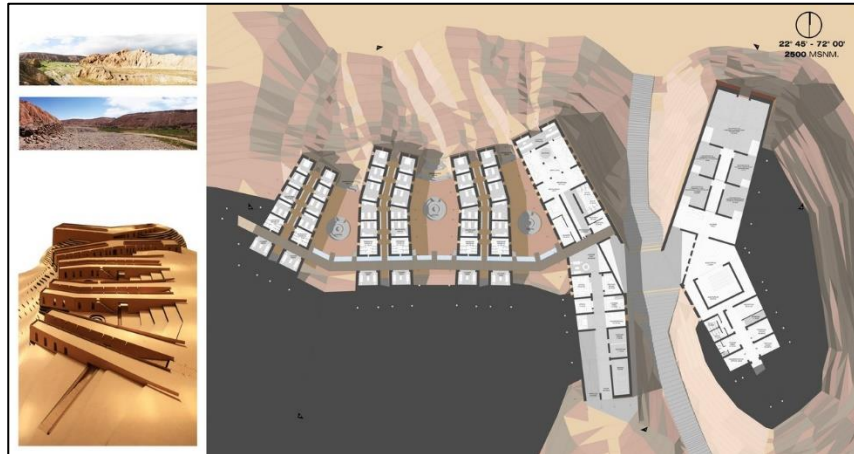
Planimetría y volumetría del centro de interpretación.
